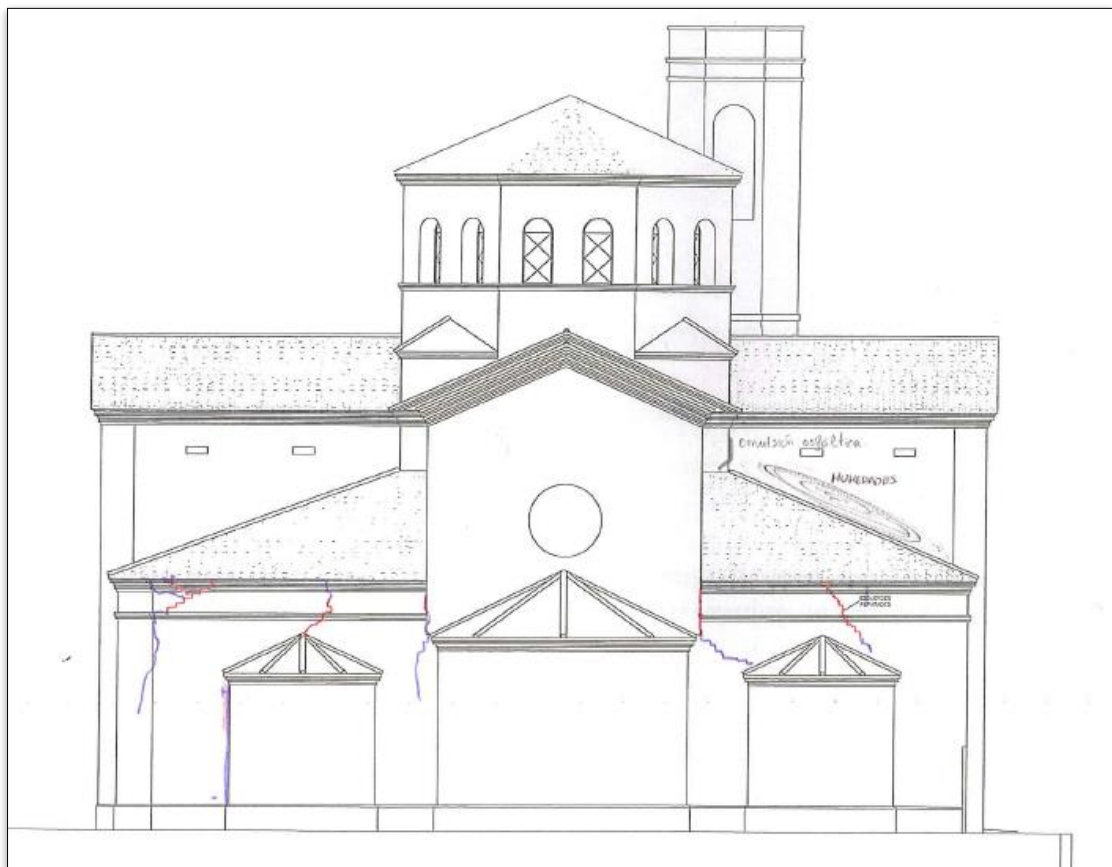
Grietas fachada norte (plano PAT. 16)
